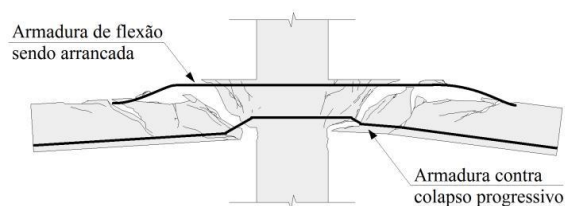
Armadura superior e inferior na ligação laje-pilar (SANTOS, 2016)
